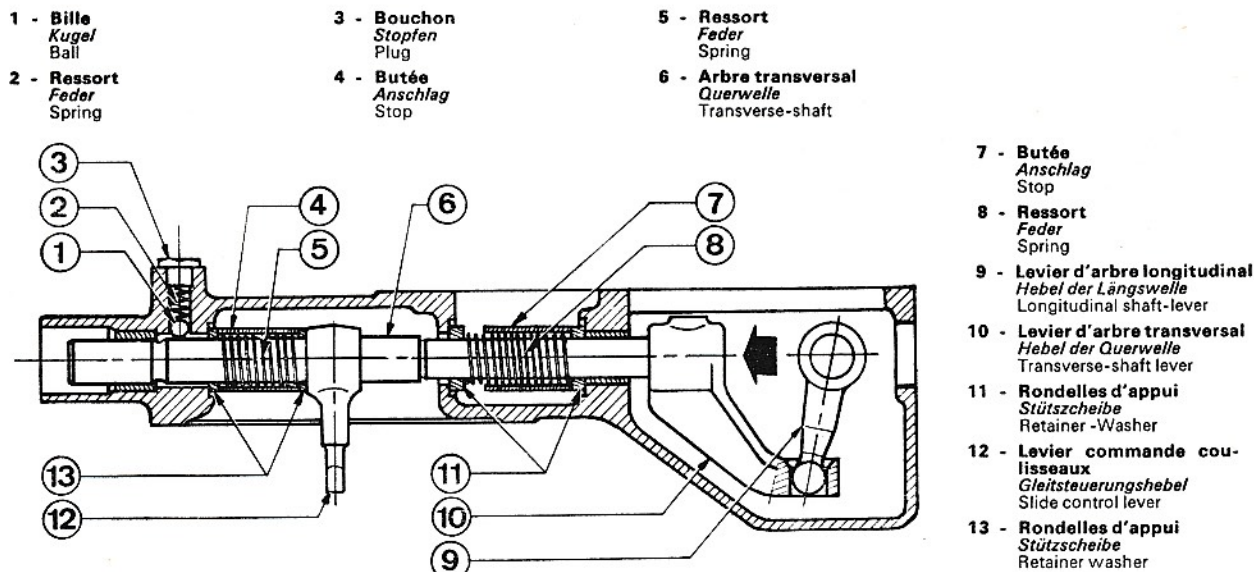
D 4 - Coupe du couvercle de Cde à distance
